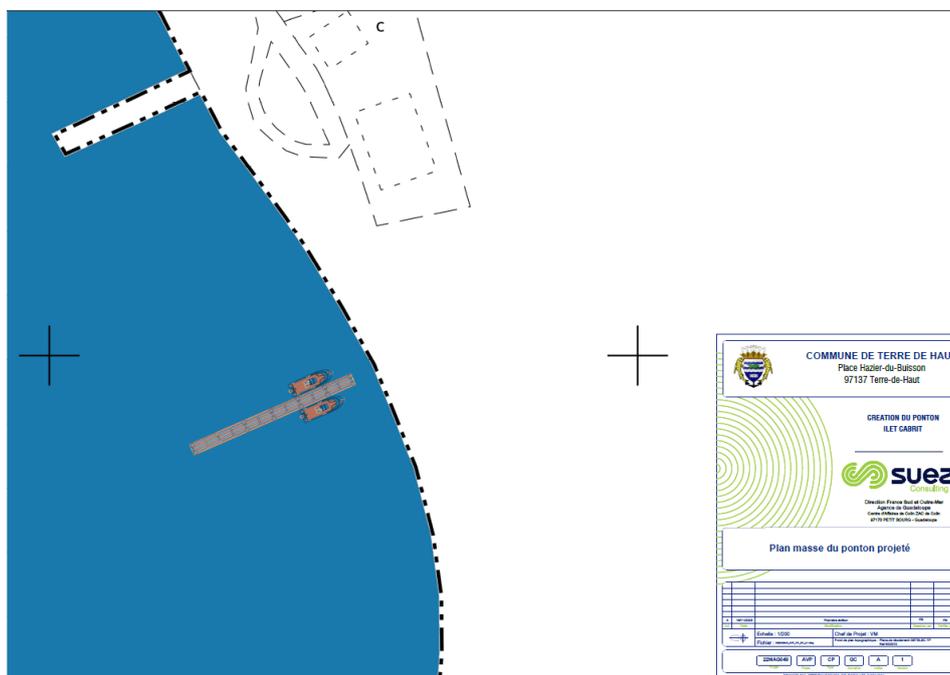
Plan de masse de l'aménagement (source : AVP Suez Consulting, novembre 2023)
